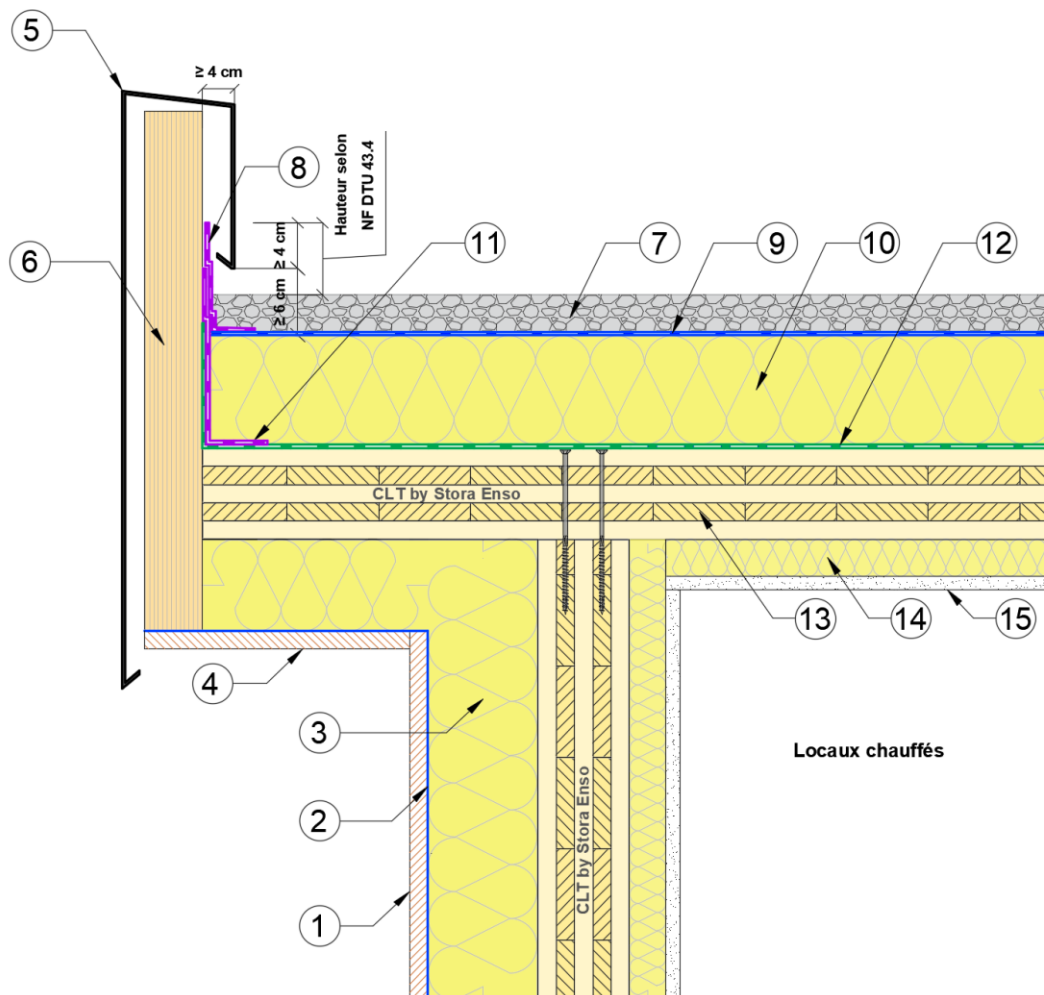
Exemple de traitement d'un relevé en configuration de toiture inaccessible isolée sur bâtiment chauffé avec isolation support d'étanchéité - Mur filant acrotère en CLT by Stora Enso avec isolant de relevé - Coupe perpendiculaire à la pente.
